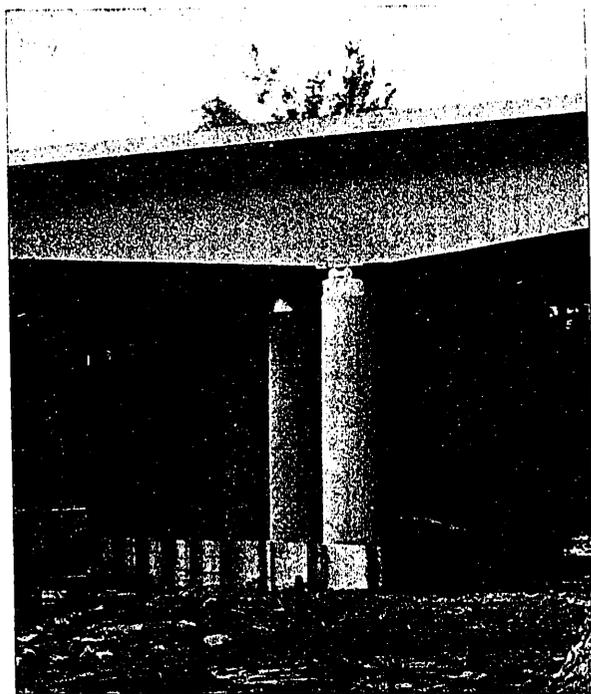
Aspecto de las columnas con los aparatos de articulación móvil
